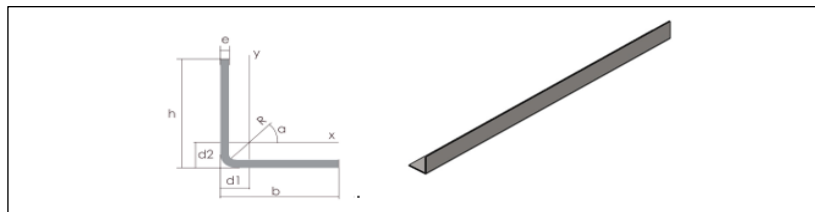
Perfil estructural: Ángulo “L” doblado
